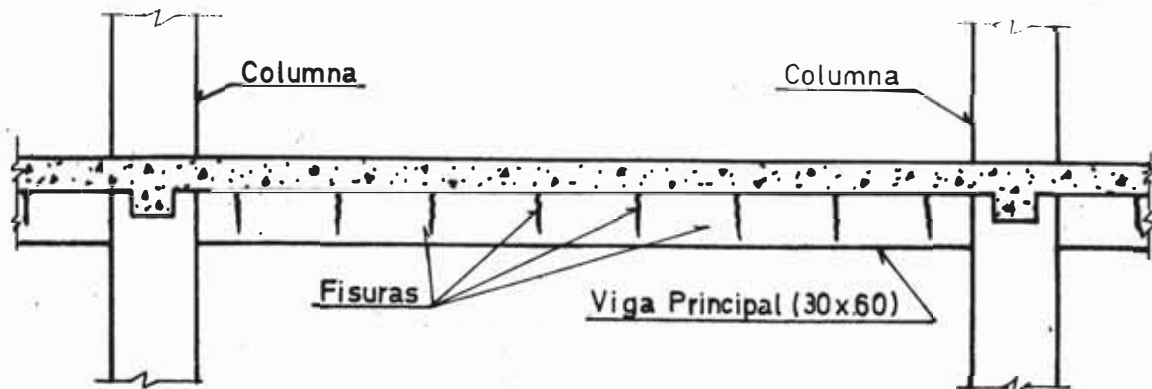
Fisuras en vigas principales de niveles intermedios. Parten del techo sin llegar a la base de la Viga.
